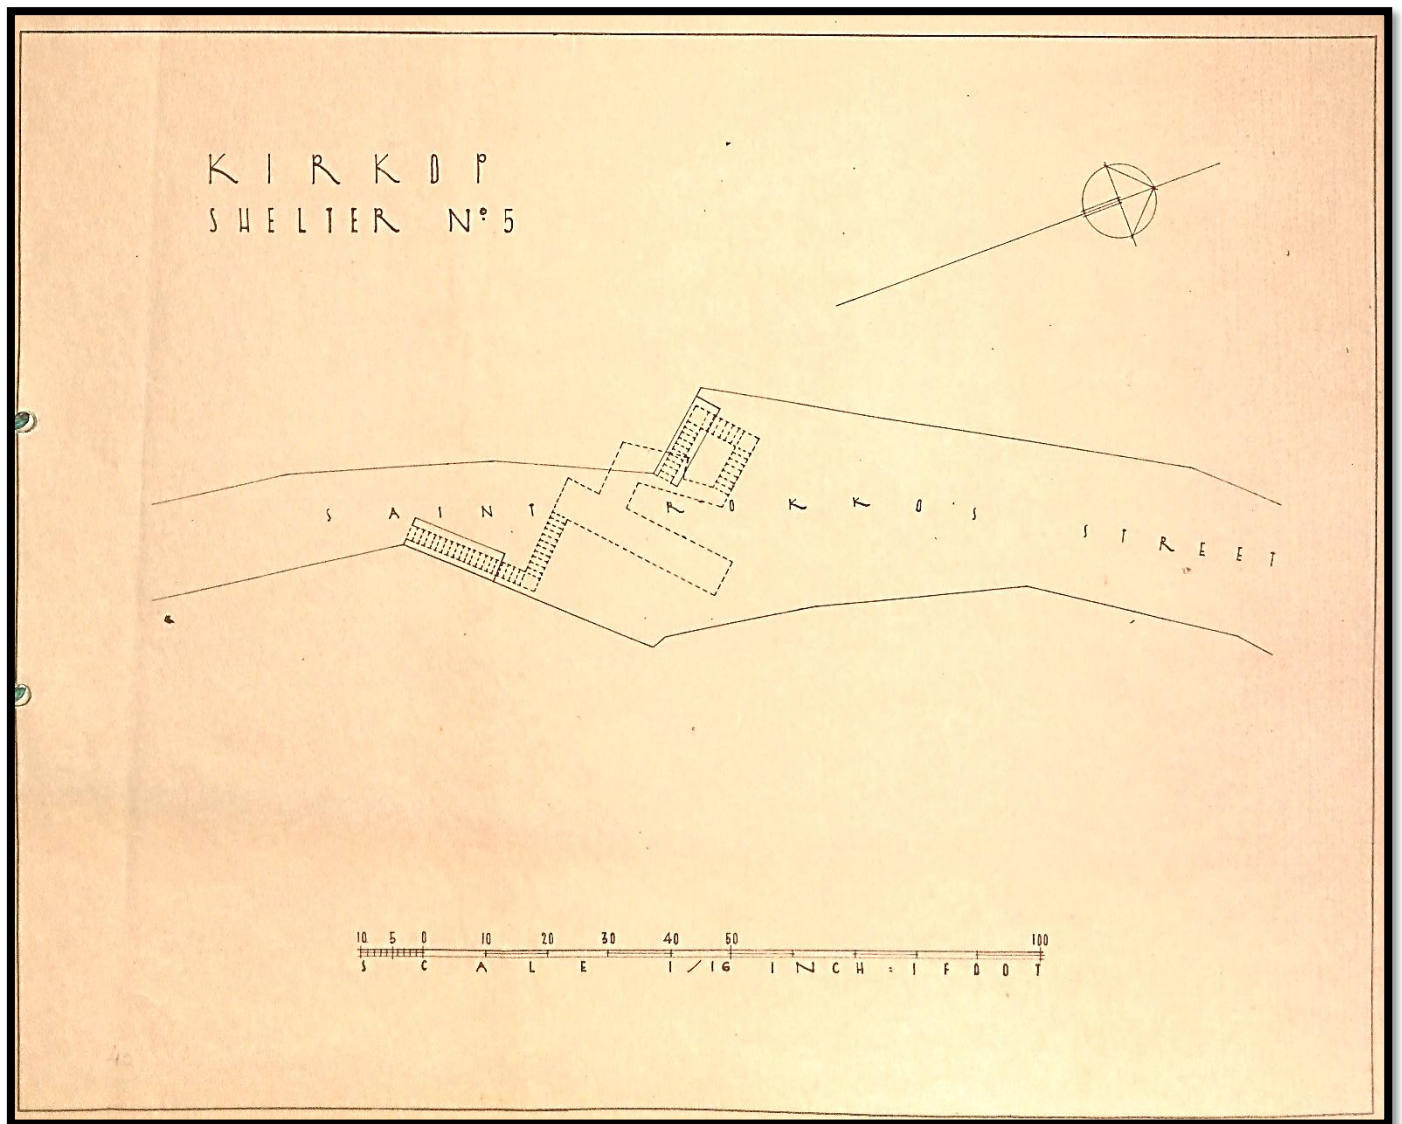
Planta do Abrigo nº5 "Saint Rokko Street"
